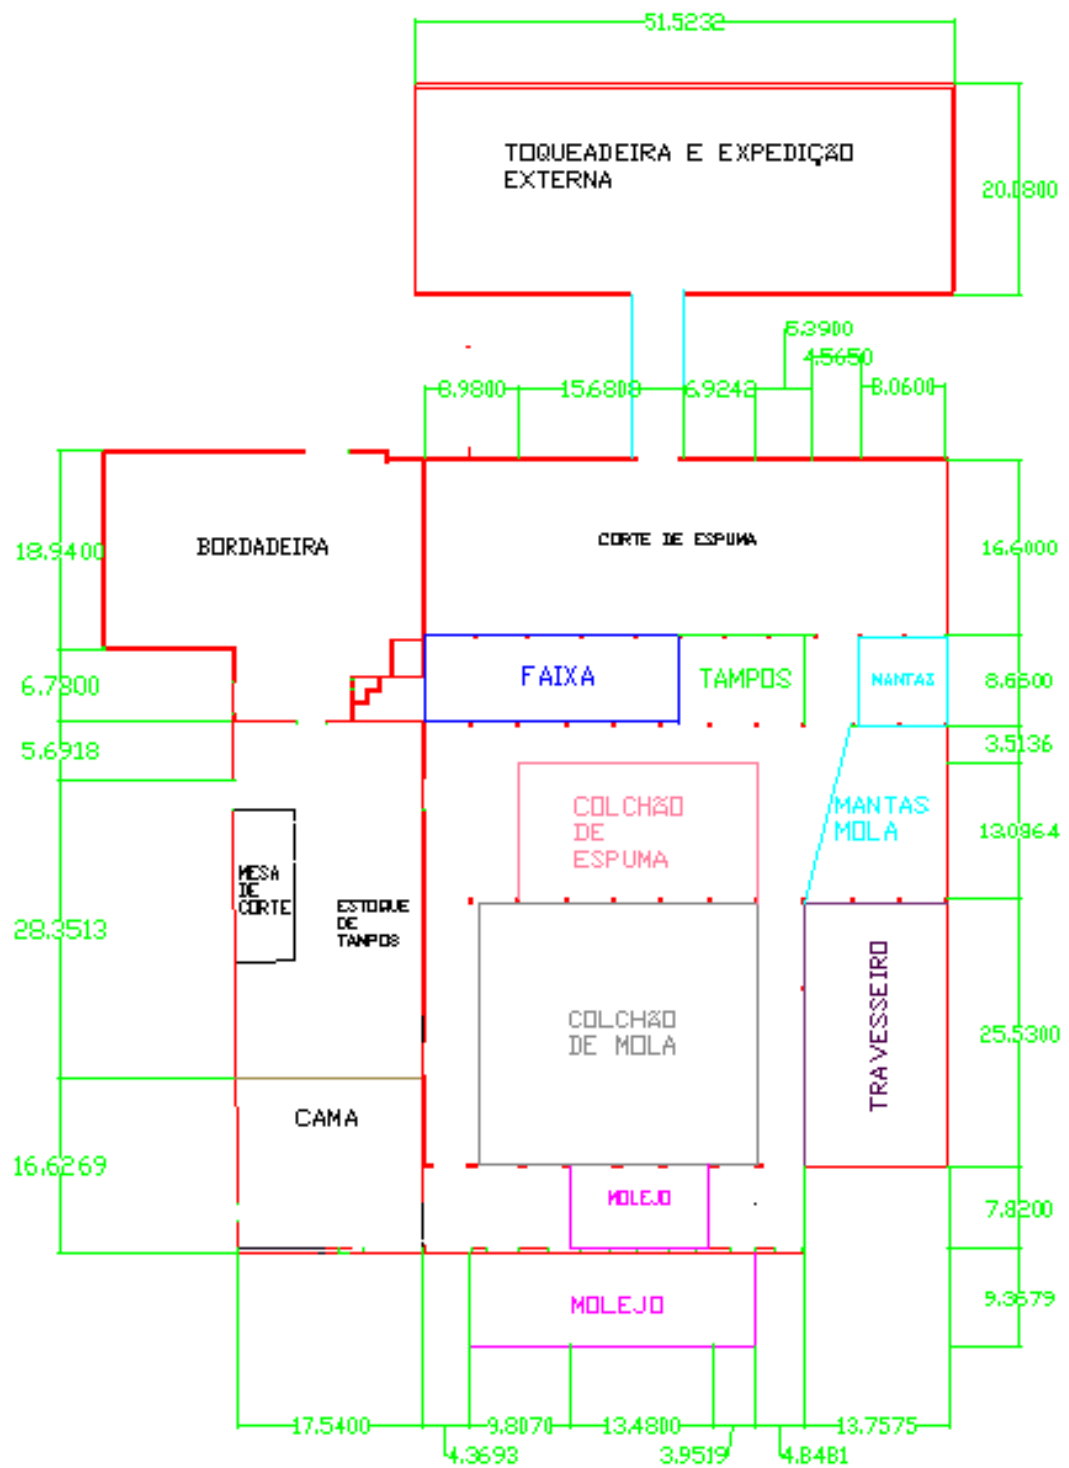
Planta baixa F.A Maringá Antes do projeto
